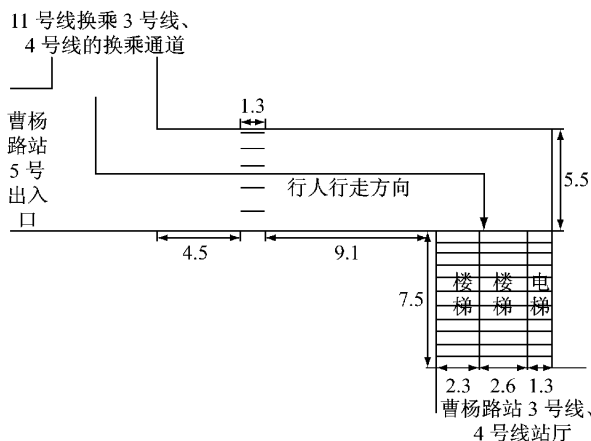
上海曹杨路站换乘通道的栏杆设置平面图 (单位: m)
